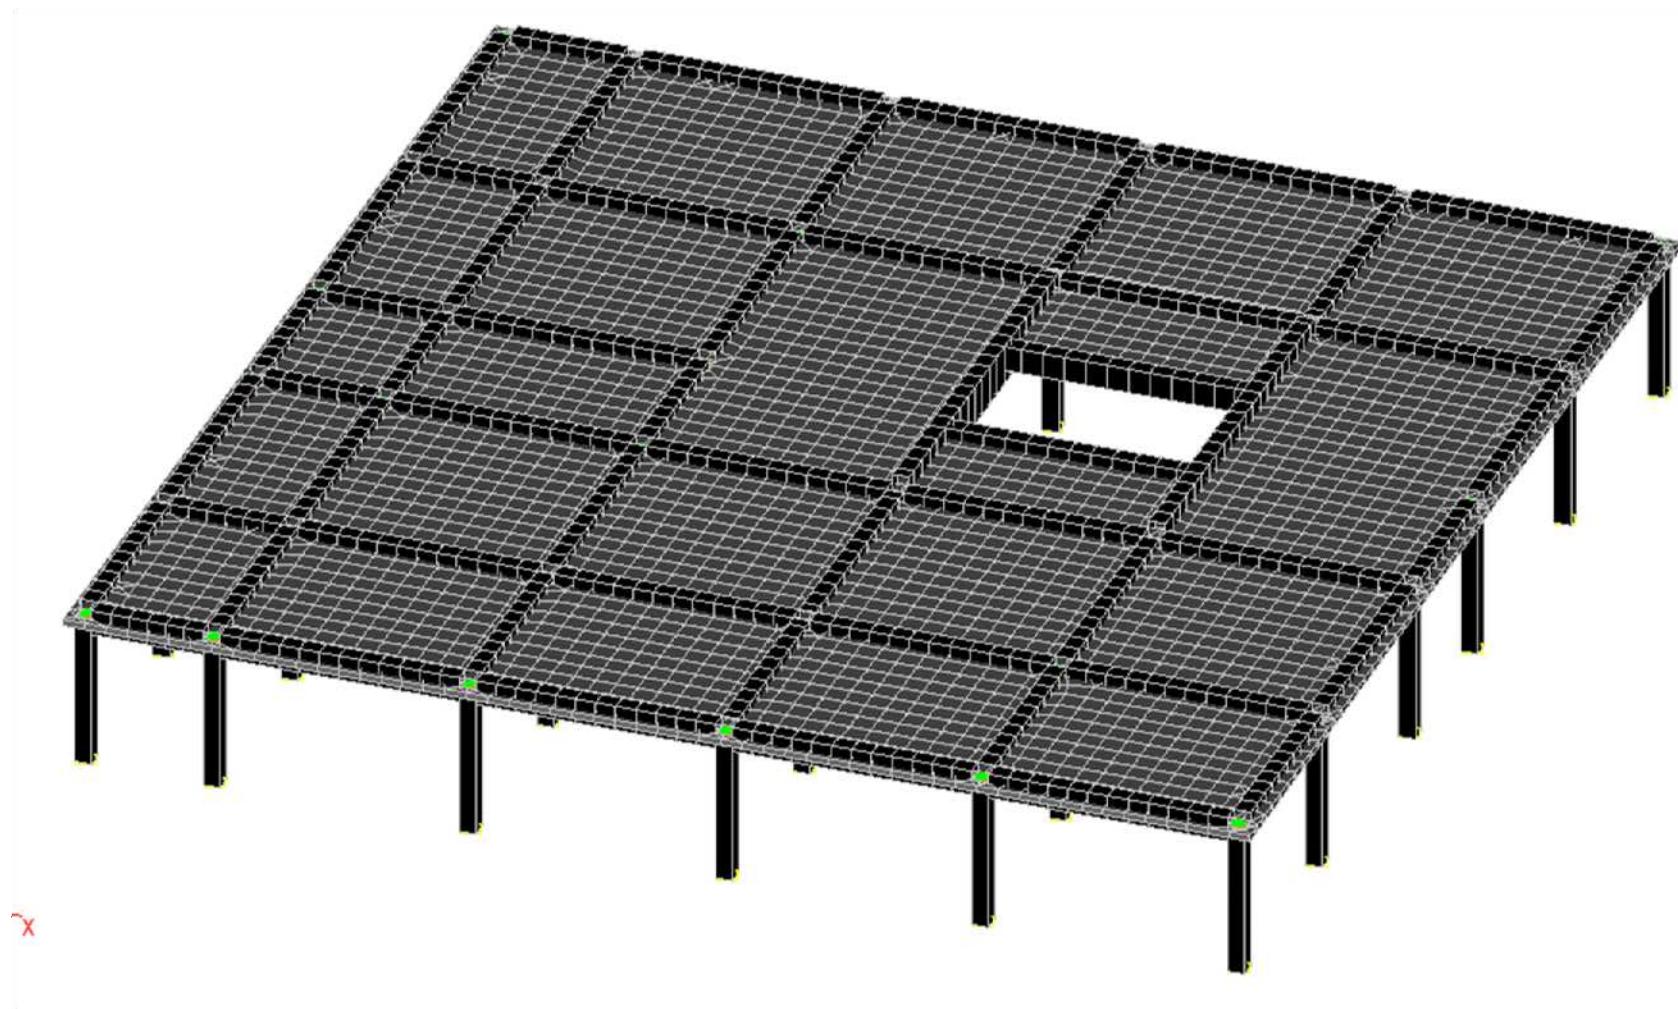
Расчетная конечно-элементная схема междуэтажного перекрытия
